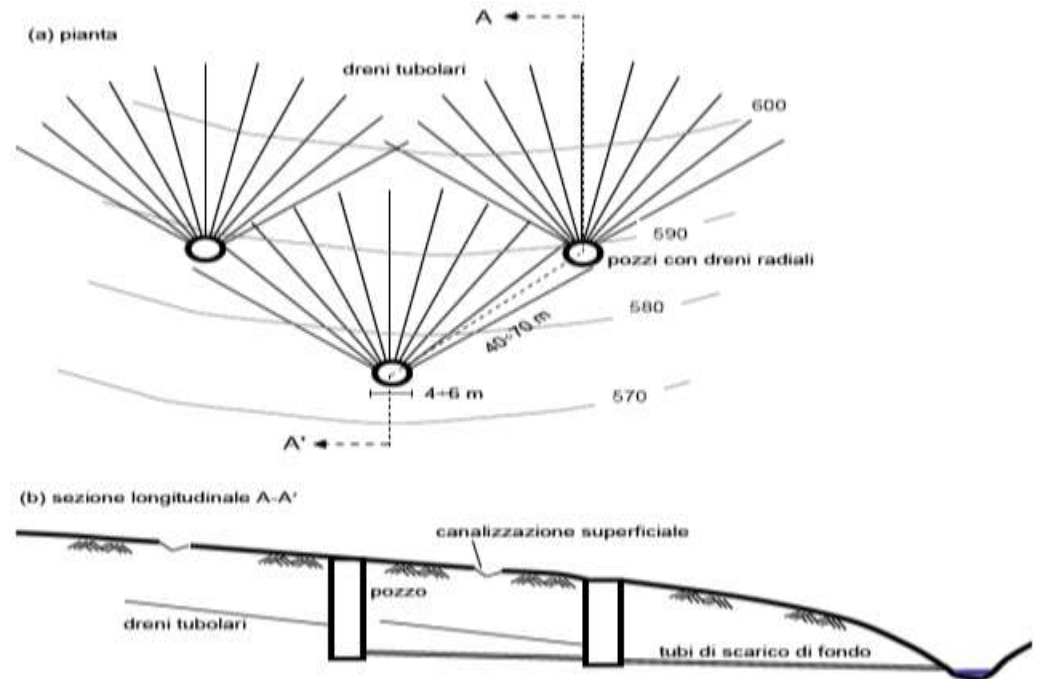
Schema di dreni tubolari installati da pozzi (adattata da Pun e Urciuoli, 2008)
